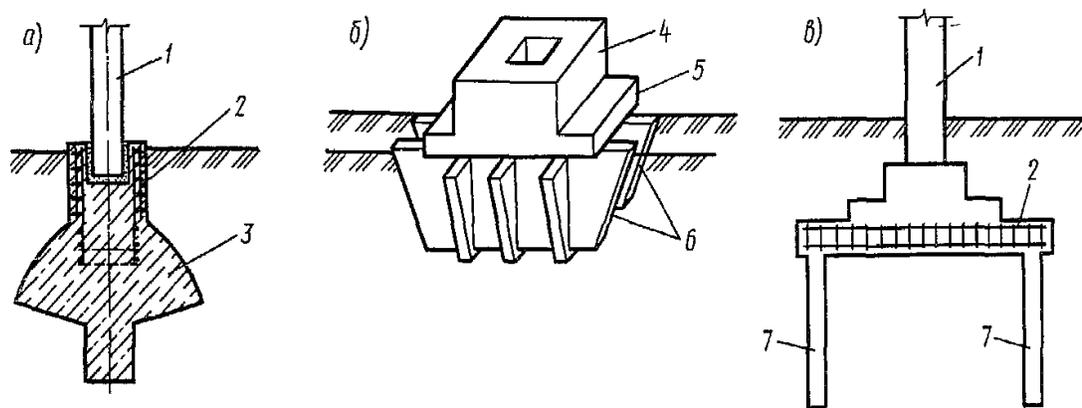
Буробетонные (а), щелевые (б) и анкерные (в) фундаменты:
